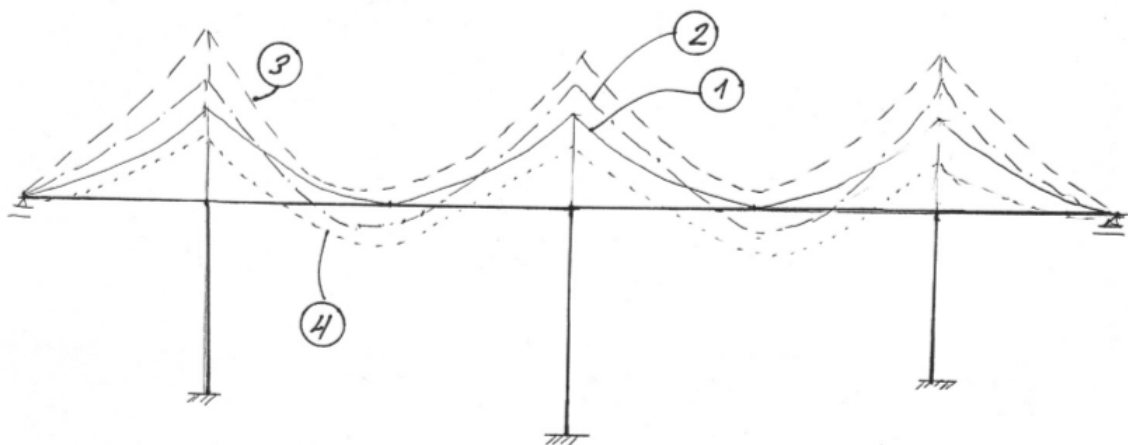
Напрягаща армировка и моменти в строително състояние:
